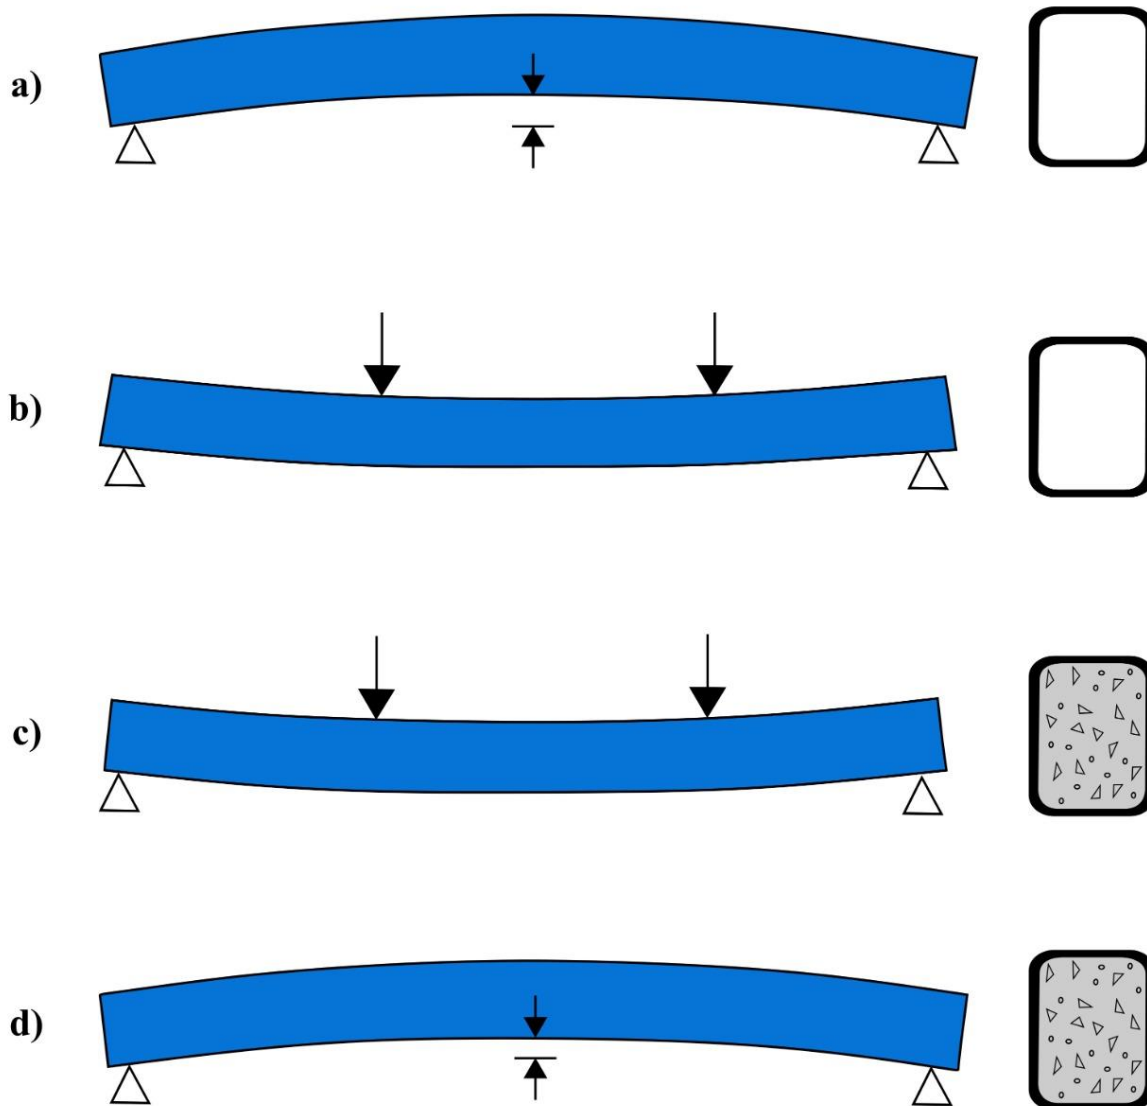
Processo de fabricação viga "Preflex" para perfis tubulares preenchidos com concreto: (a) viga de aço na posição inicial; (b) aplicação das forças verticais; (c) preenchimento do tubo de aço por concreto; (d) retirada das forças verticais.
